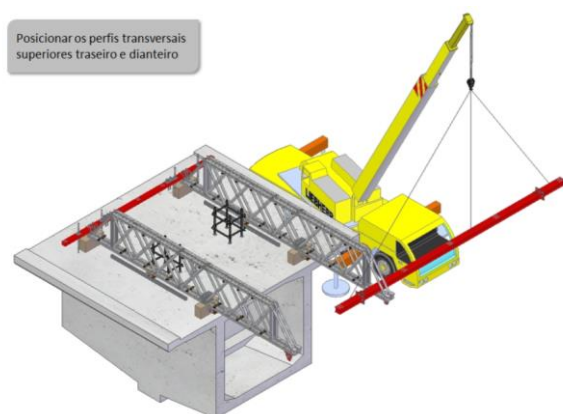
Posicionamento de perfis transversais superiores
